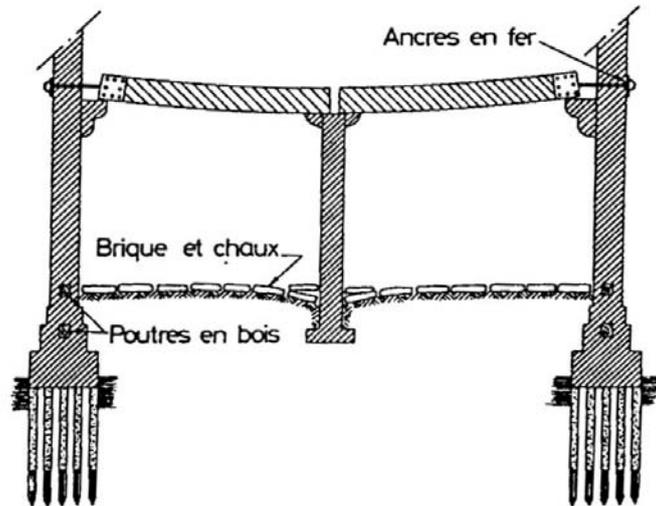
Cimentación de un palacio veneciano (Kerisel, 1985)
